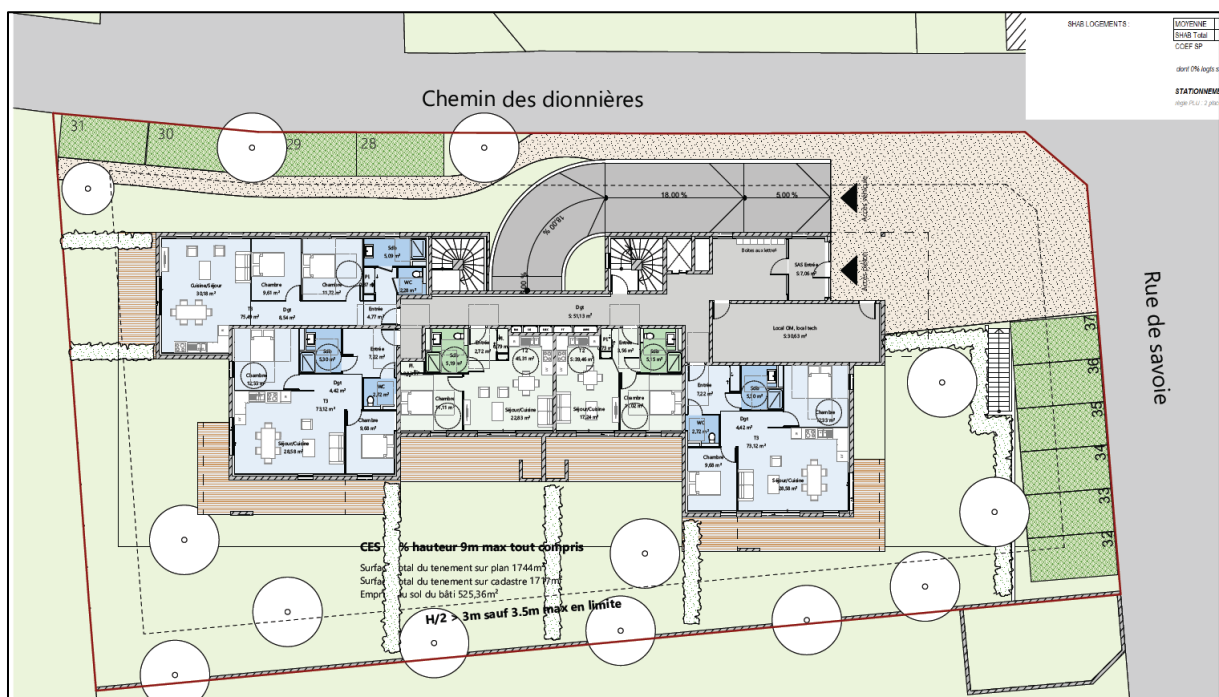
Plan de rez-de-chaussée du projet (source : [3])
